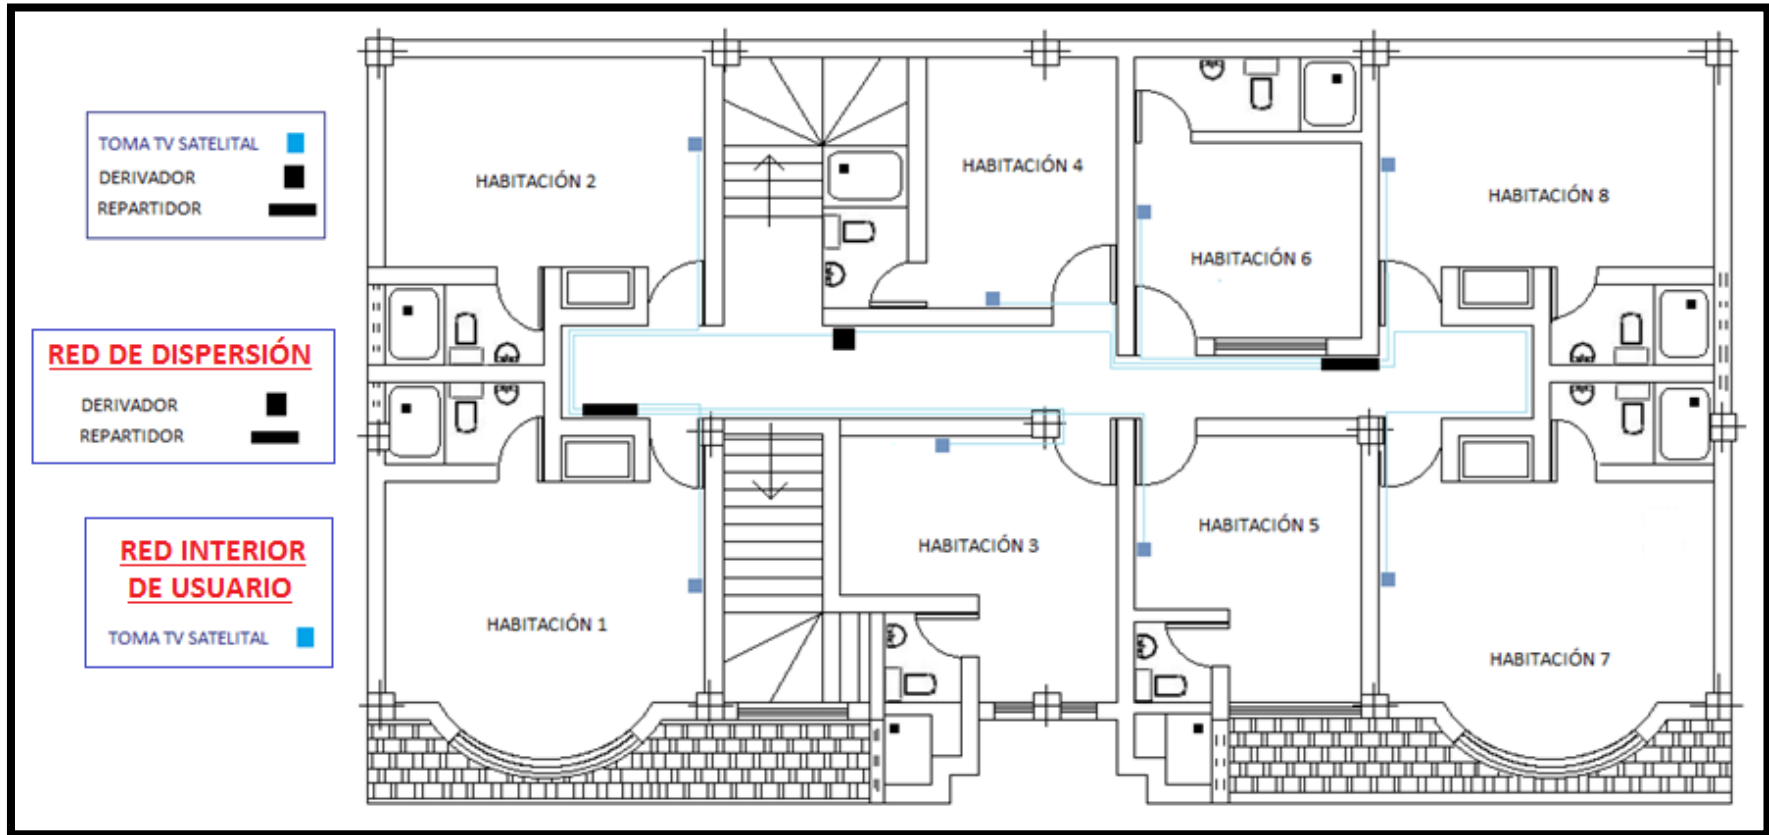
Puntos de TV satelital – Plano Primera Planta
